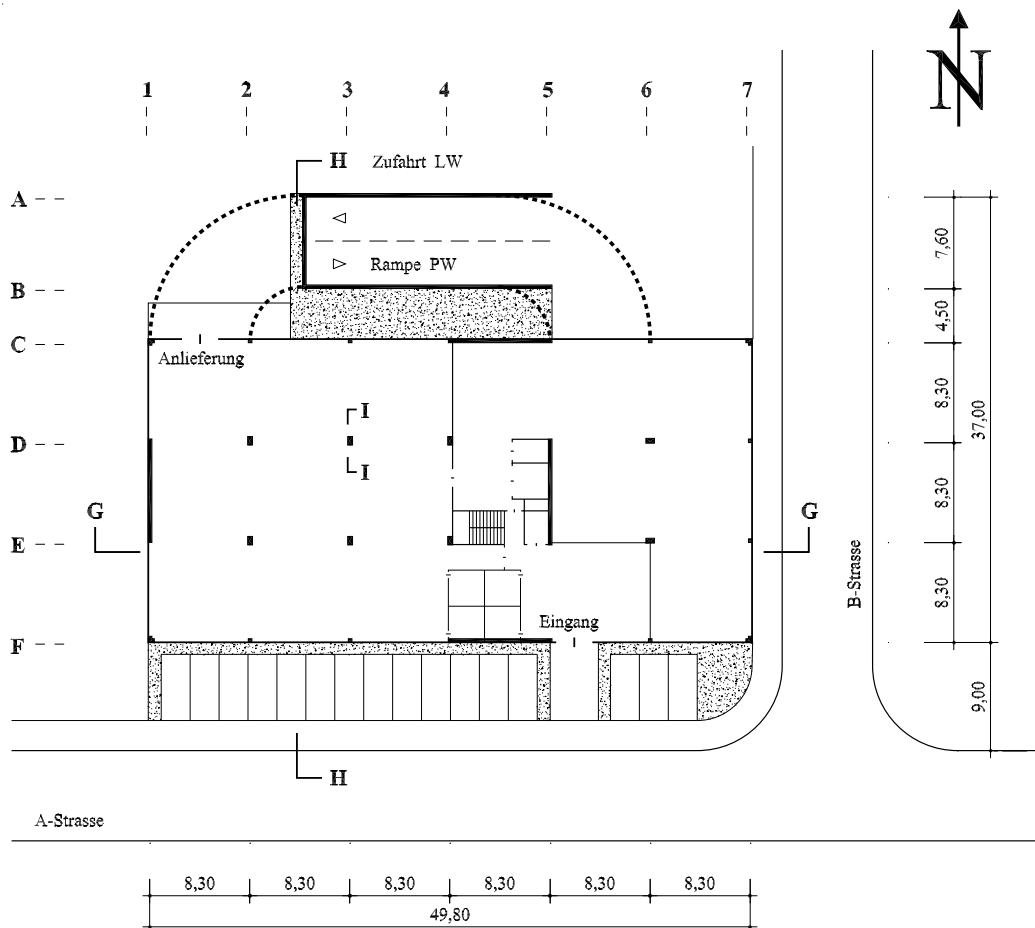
Grundriss EG (Abmessungen in m)
